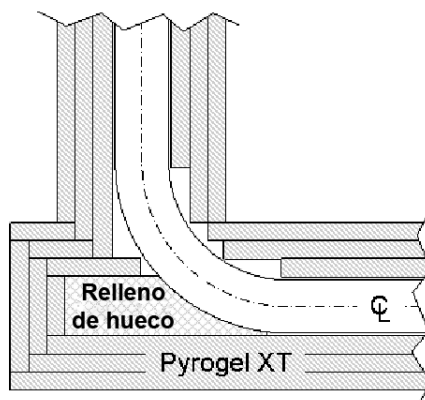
detalles del aislamiento para tubos o codos de pequeño calibre y empalme soldado
